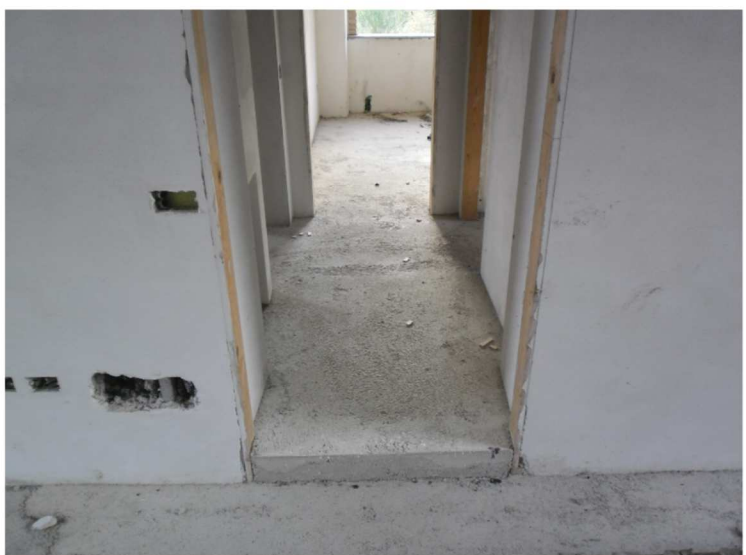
Piano Primo Dis. Camere - Figura 10 Piano Terra Fondaci
